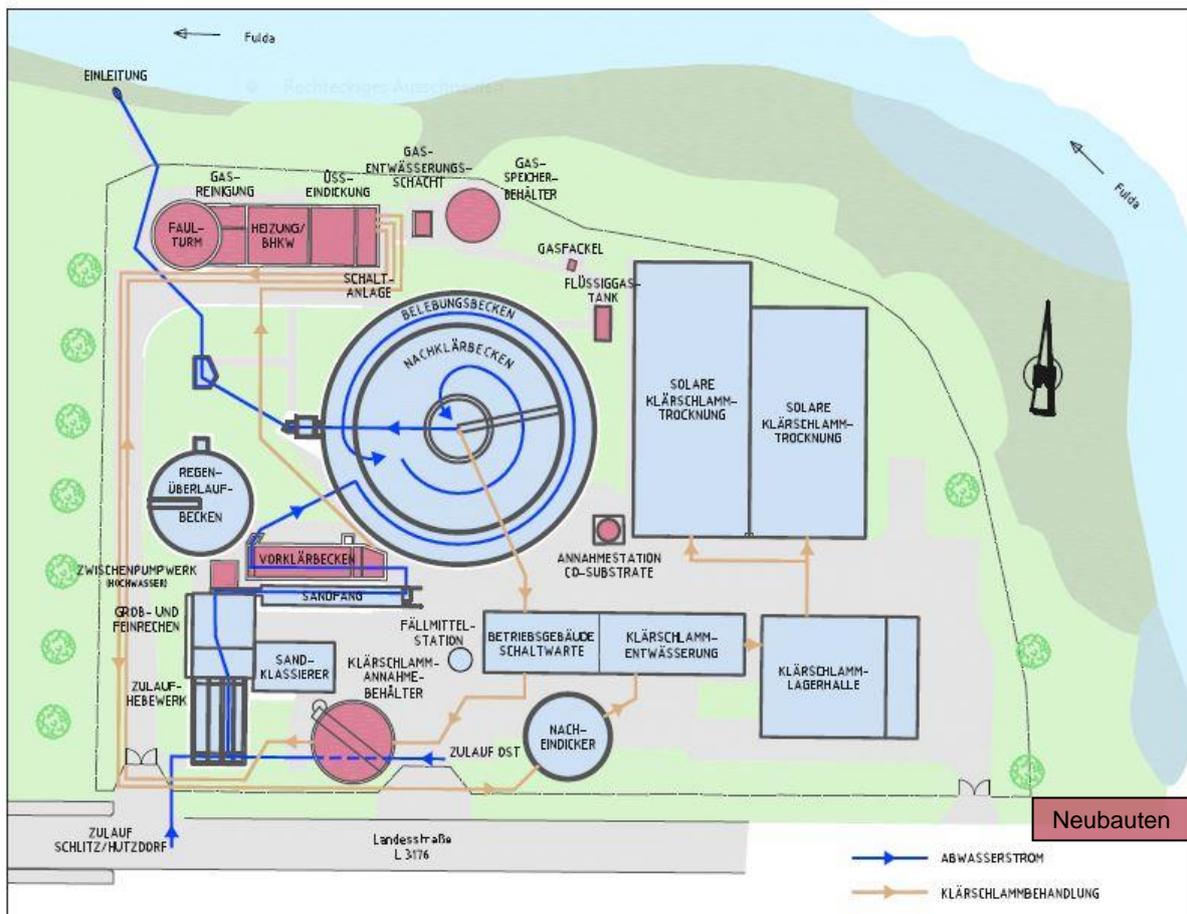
Lageplan nach Umbau (Stadtwerke Schlitz)
